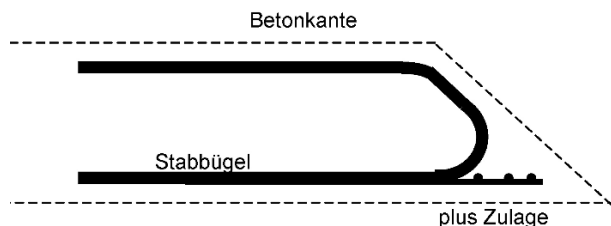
Vorschlag für eine Bewehrungslösung zur „Rettung“ des Kantenproblems im Bild 4.13
